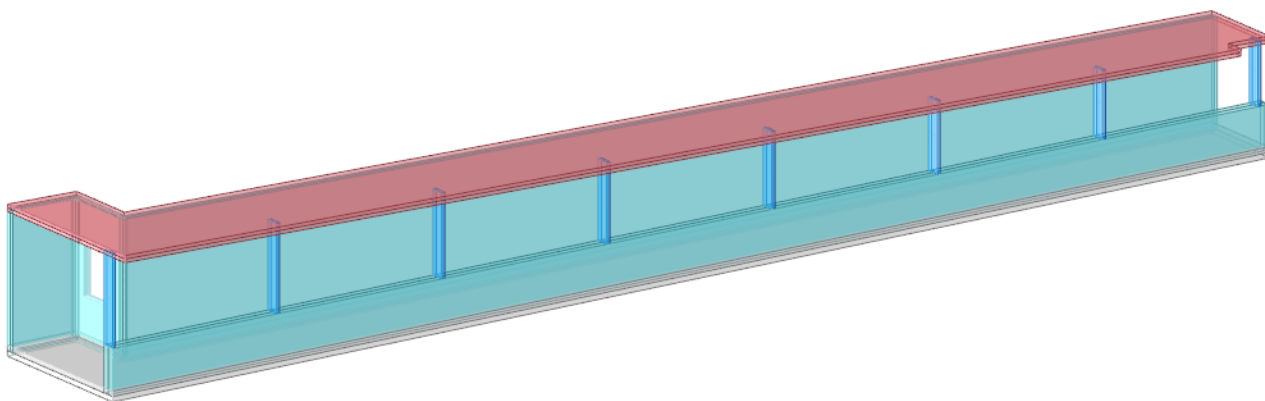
Vista 3D del Modello Strutturale FEM – Corpo B – Vista Assonometrica – Stato di Progetto
